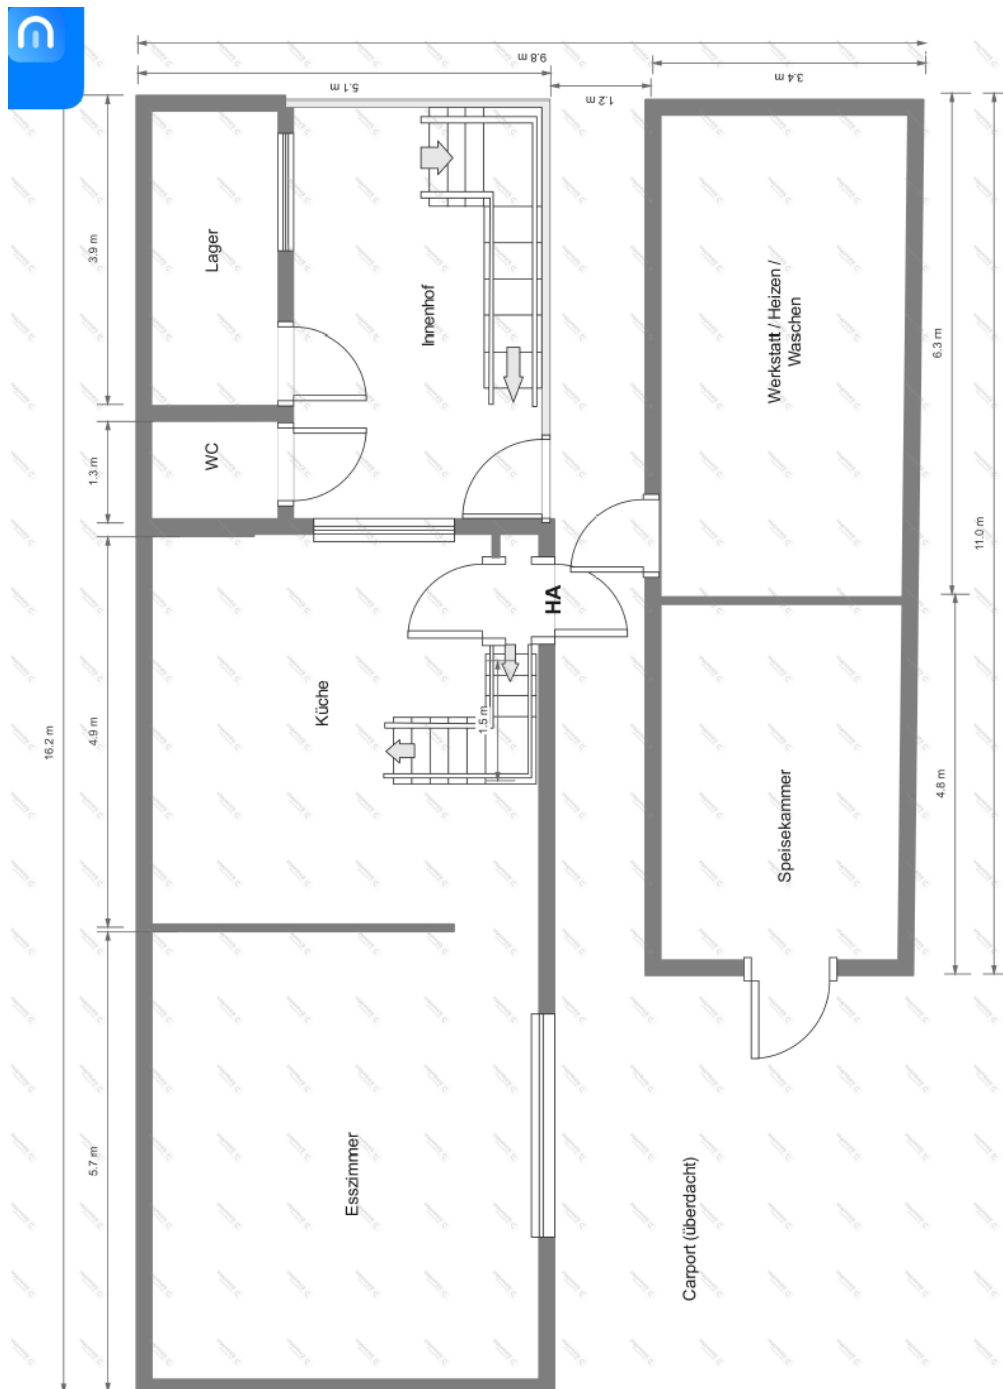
Grundriss EG, nicht maßstabsgetreu, Maße ohne Gewähr
